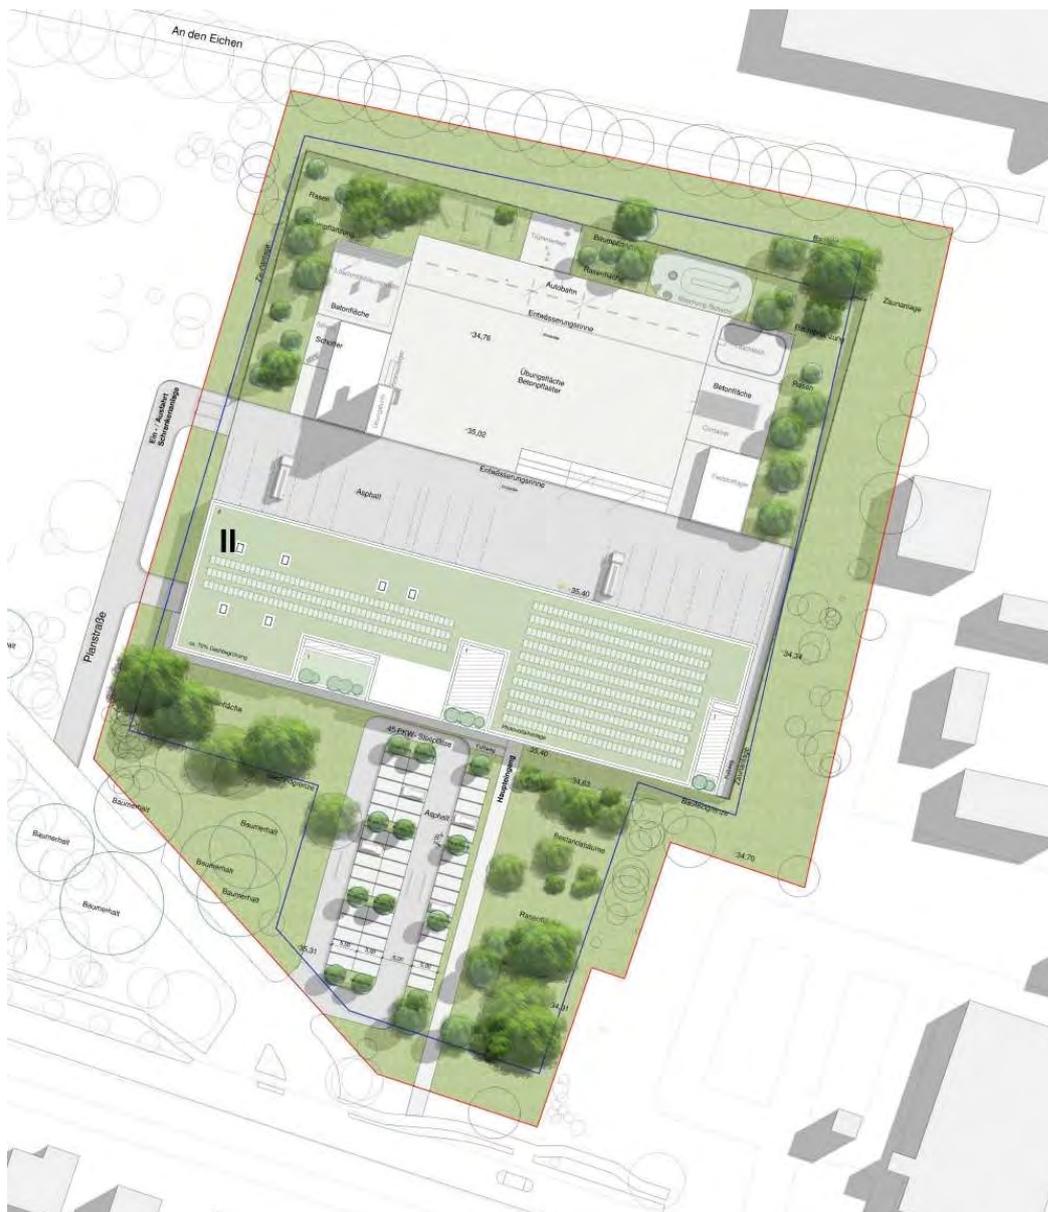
Lageplan Gatermann+Schossig, Januar 2020 (Quelle: Landkreis Oberhavel)
